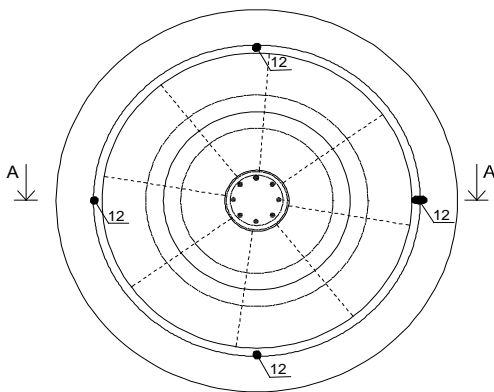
План сейсмоизолирующего тарельчатого фундамента
